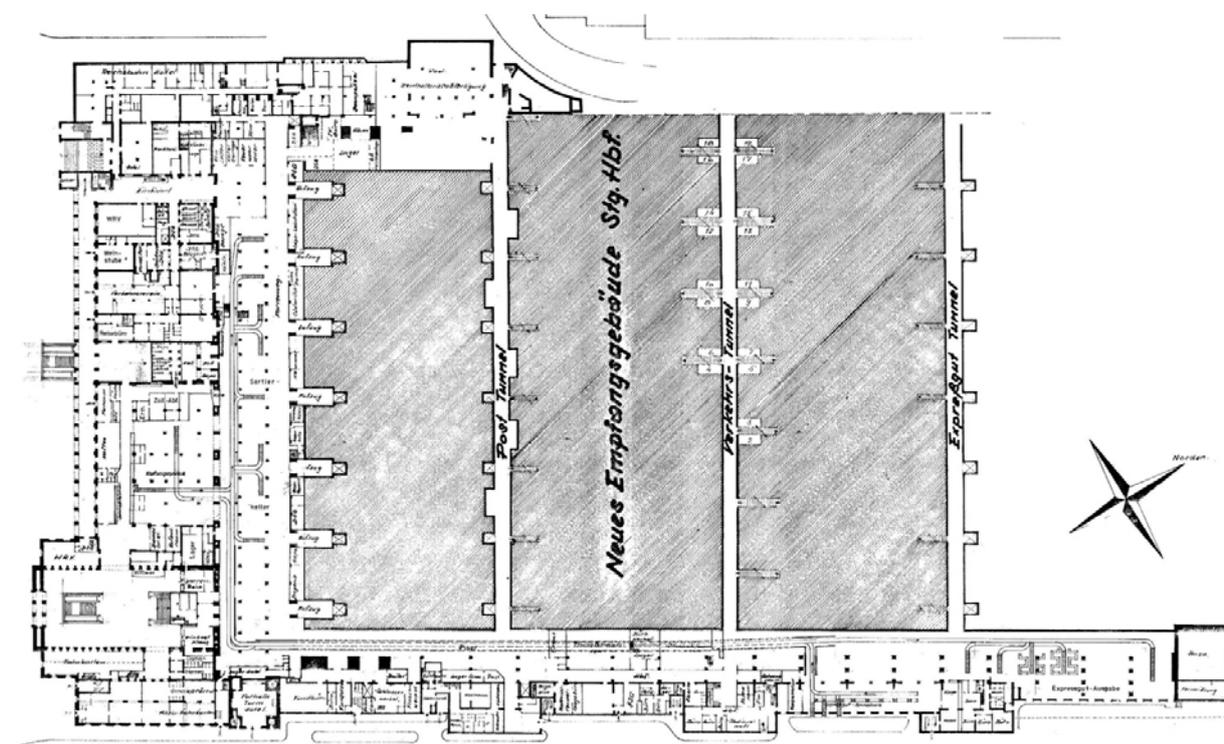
Plan nettoyé du rez-de-chaussée, de 1981 - Source : Archives du Land de Baden Württemberg
